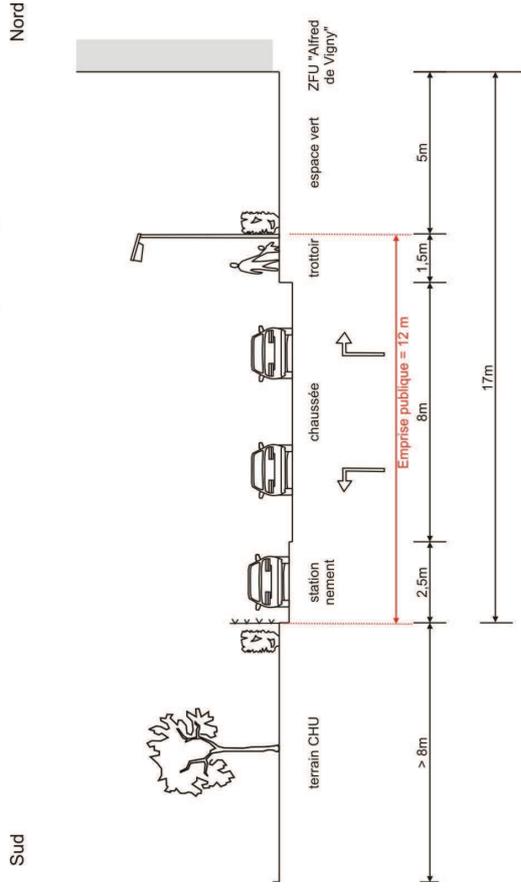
Situation existante coupe 2 sur l'avenue Molière, station "Molière Est"
